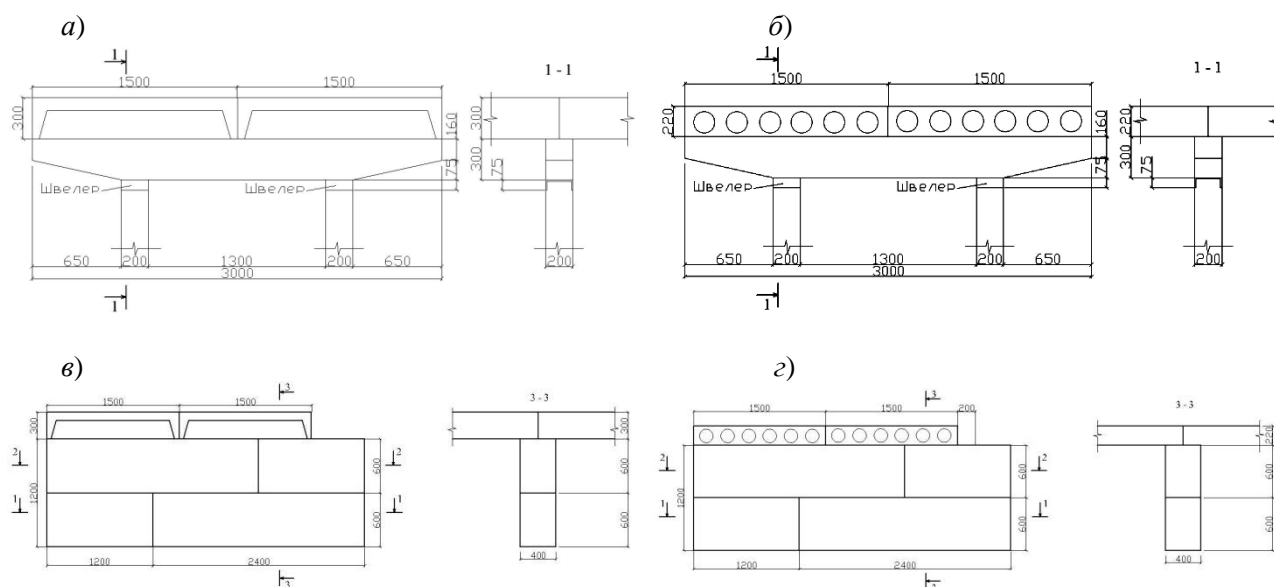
Конструкція високих пасажирських платформ: опори – залізобетонні стояки та ригель (а, б) або блоки бетонні для стін підвалів (в, г); покриття – залізобетонні ребристі плити (а, в) або залізобетонні багатопустотні плити (б, г)
